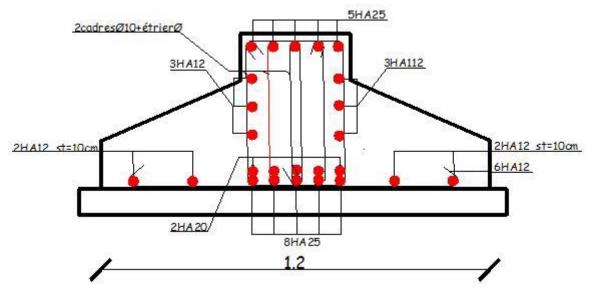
schéma de ferraillage de la semelle filante en appui (coupe transversale A-A').
